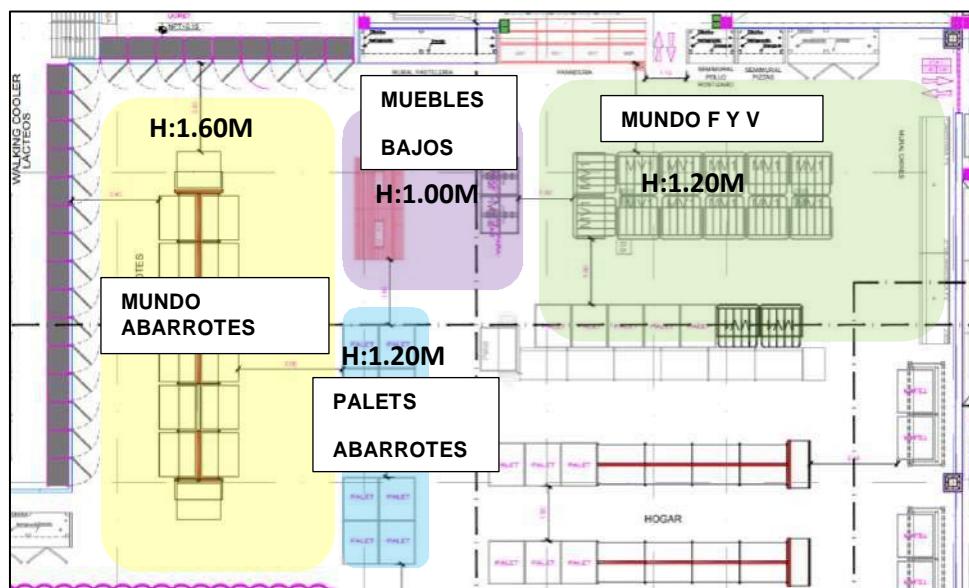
Planta de Distribución de Mundos adyacente al Frontal.
